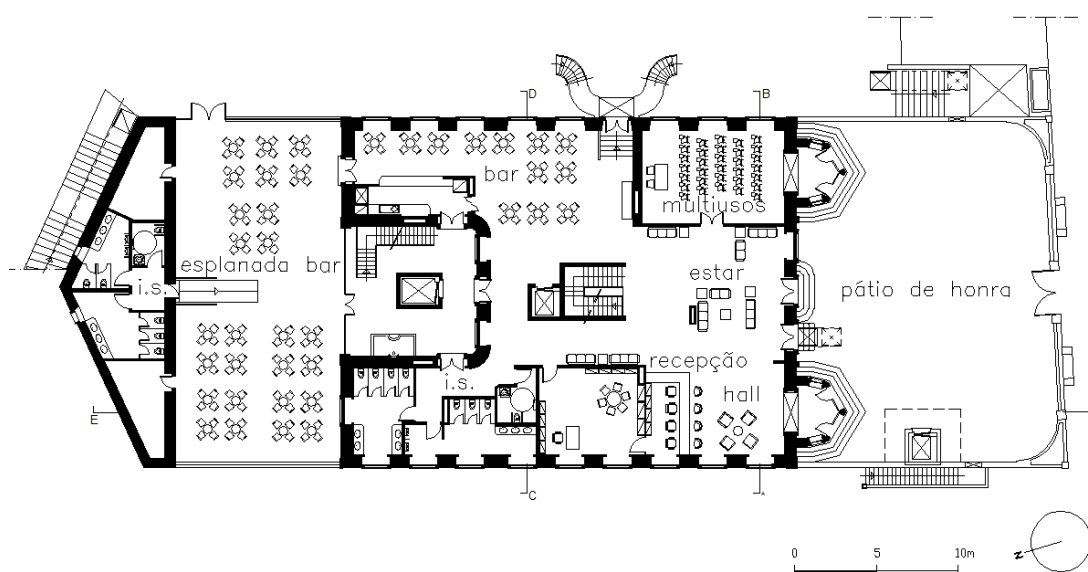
Planta do piso 0 (Palácio da Quinta da Graça).
